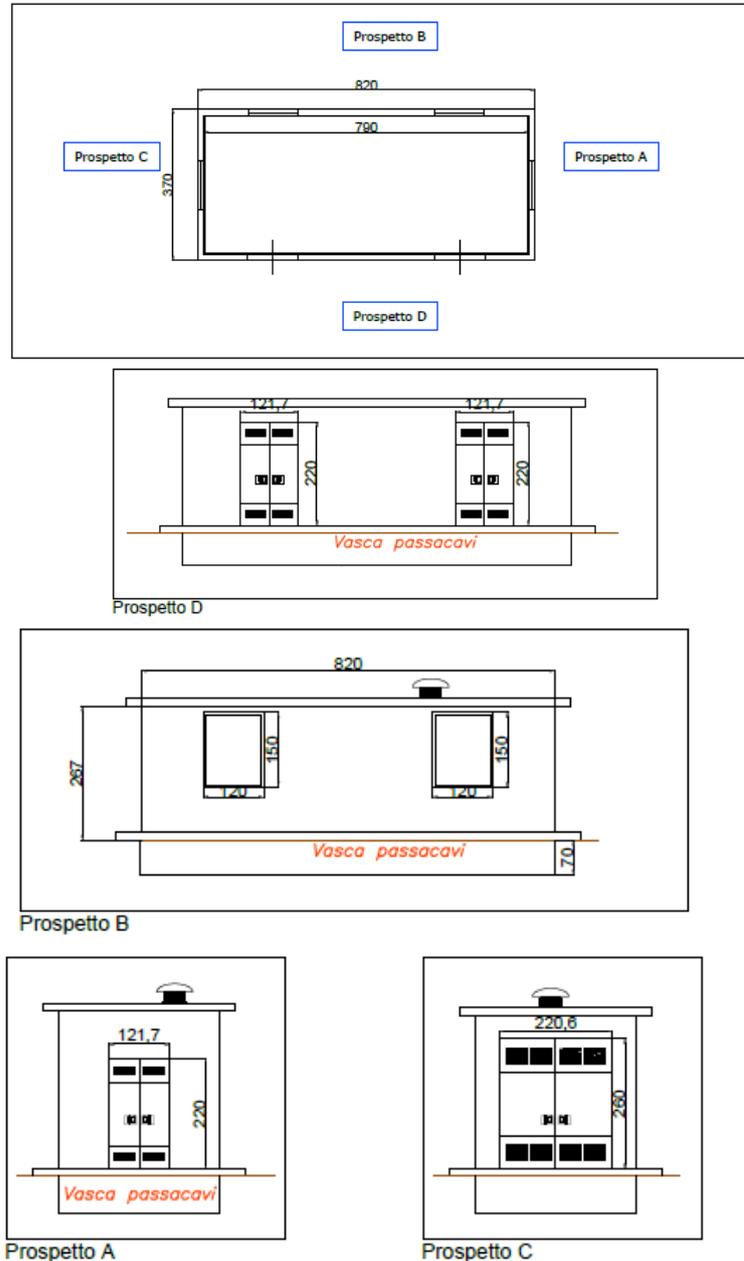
Planimetria e prospetti della cabina di controllo e monitoraggio tipo.
